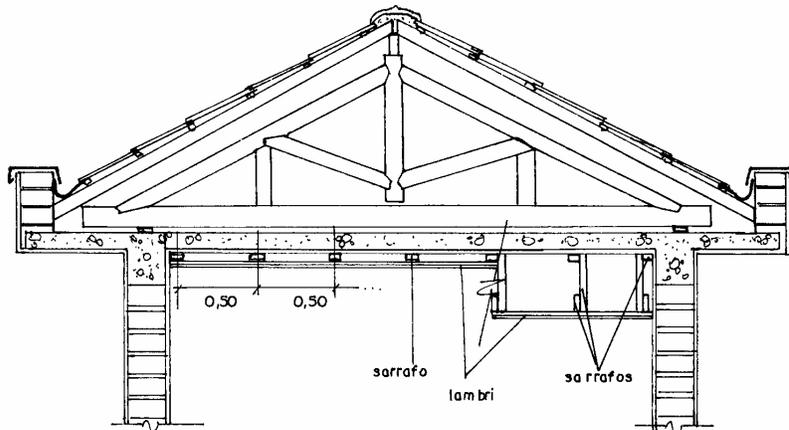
Fixação do forro em laje e em tirantes para execução de rebaxos
